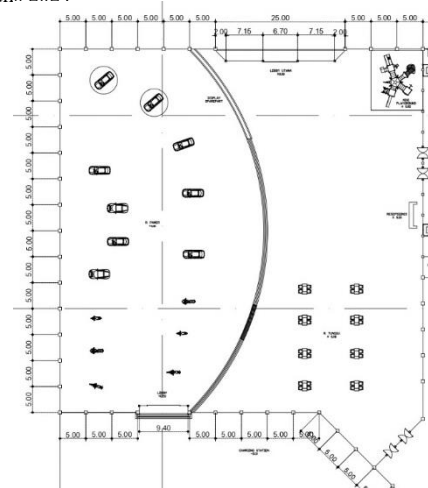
Denah Lantai 1 Electric Vehicle Center
